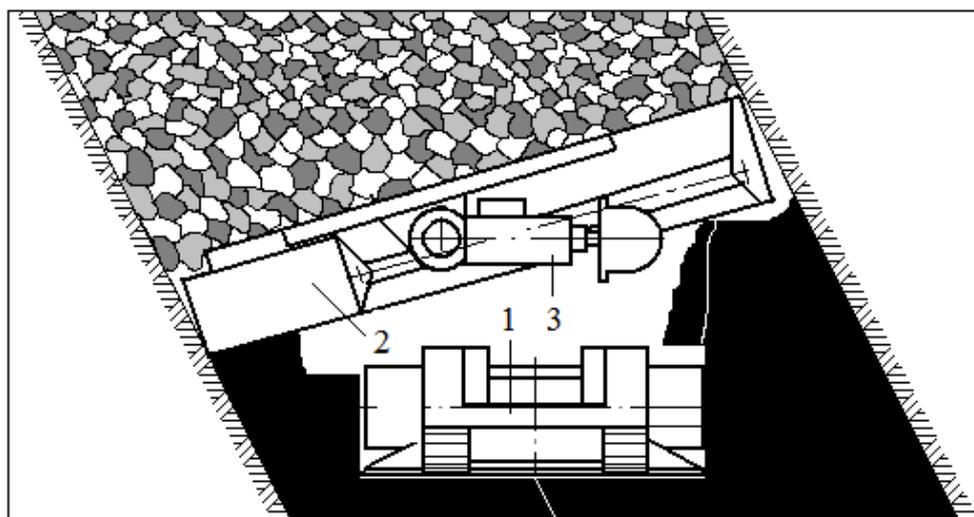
Схема размещения оборудования в рабочем пространстве слоя при отработке крутого пласта:
